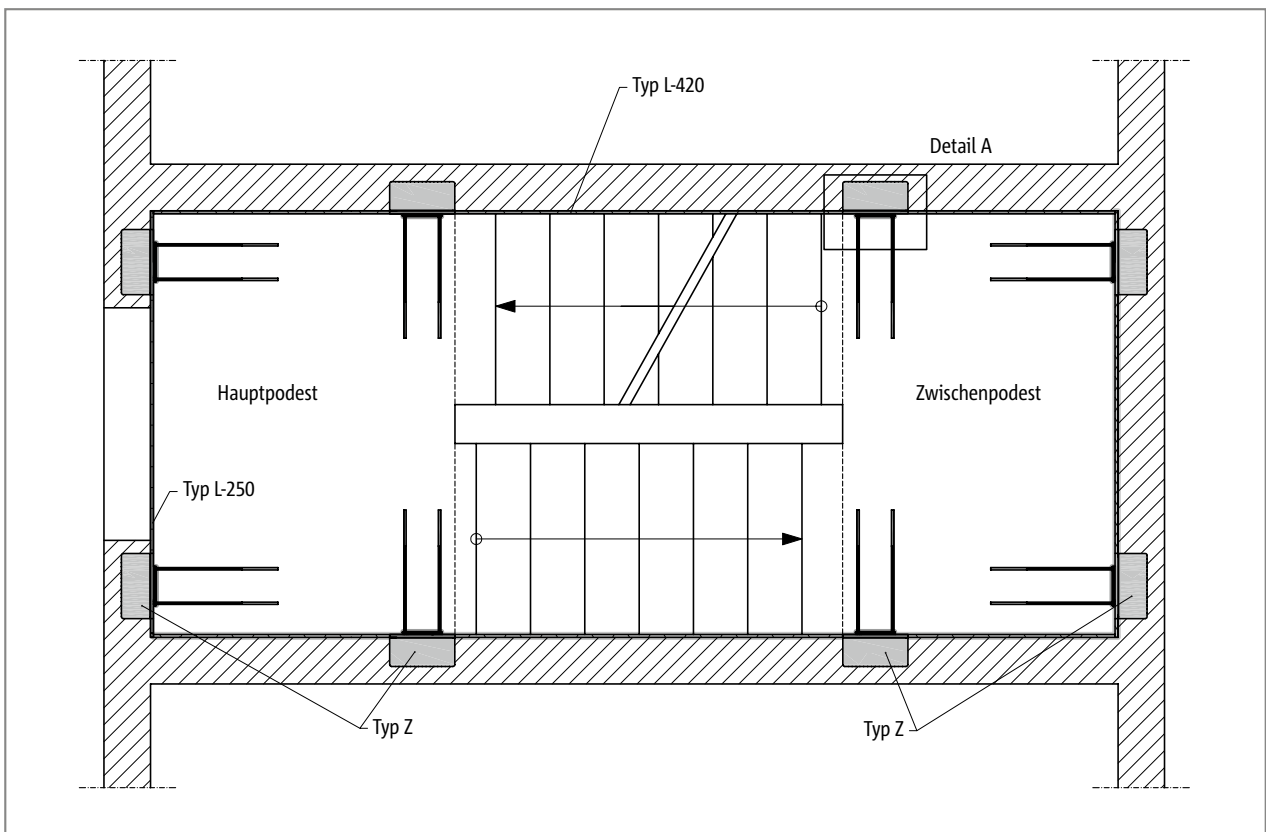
Schöck Tronsole® Typ Z: Alternative Elementanordnung im Grundriss
